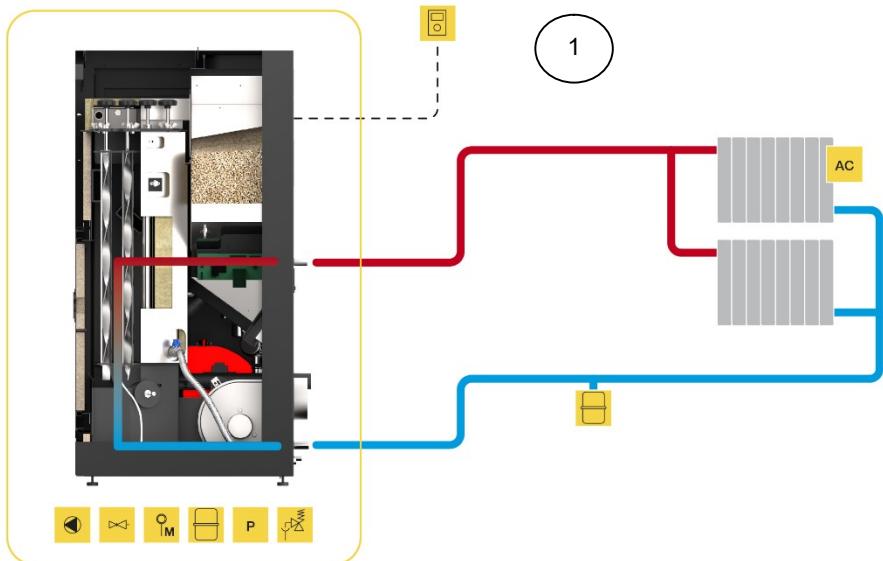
Ligação simples apenas a radiadores de aquecimento central
